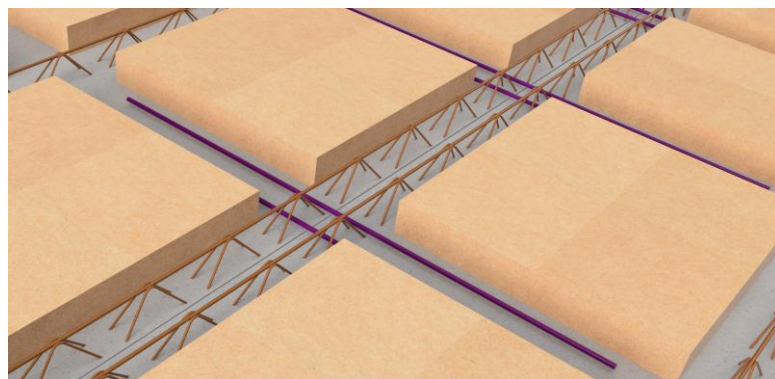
armatures sur joint - configuration joint sans paniers couture
